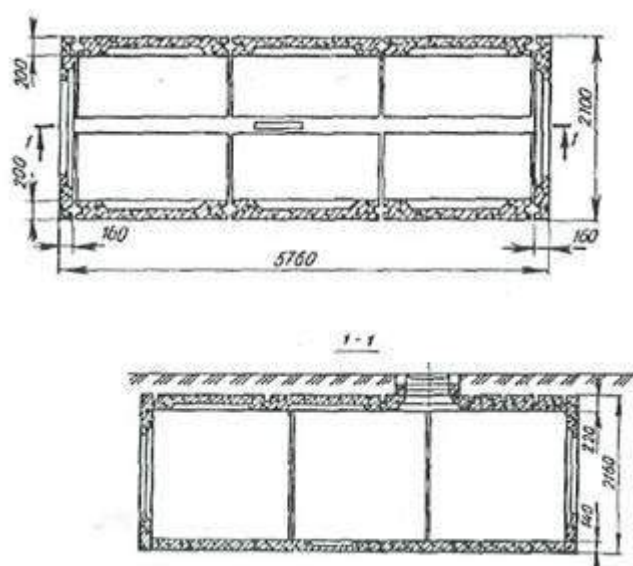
Проходной сборный железобетонный колодец специального типа ККС-2 на 37-48 каналов трубопровода.
